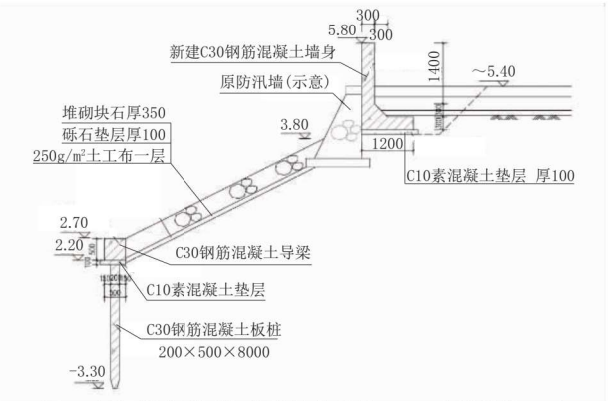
浦西防汛墙断面图(长度单位:cm;高程单位:m)
